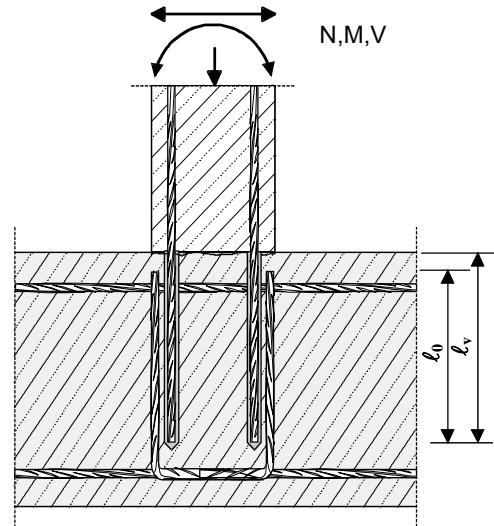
Recouvrement d'armatures pour la liaison d'un poteau ou d'un mur sur une fondation avec armatures en traction
